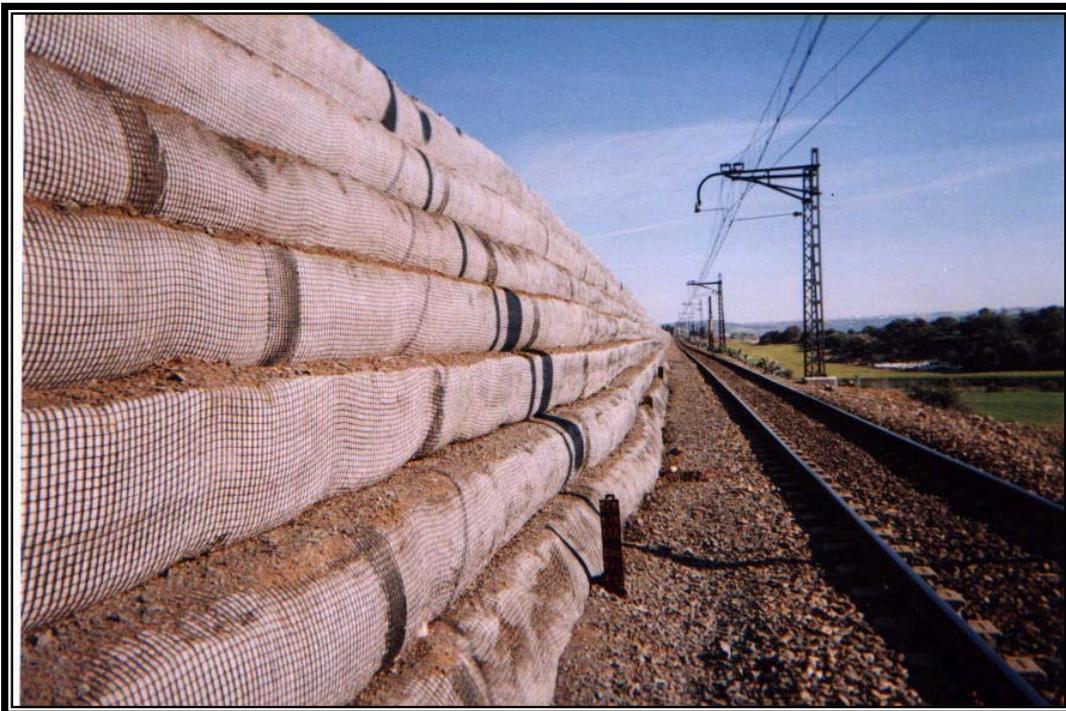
et 6 : Vue d'ensemble du projet de 400 m de long
